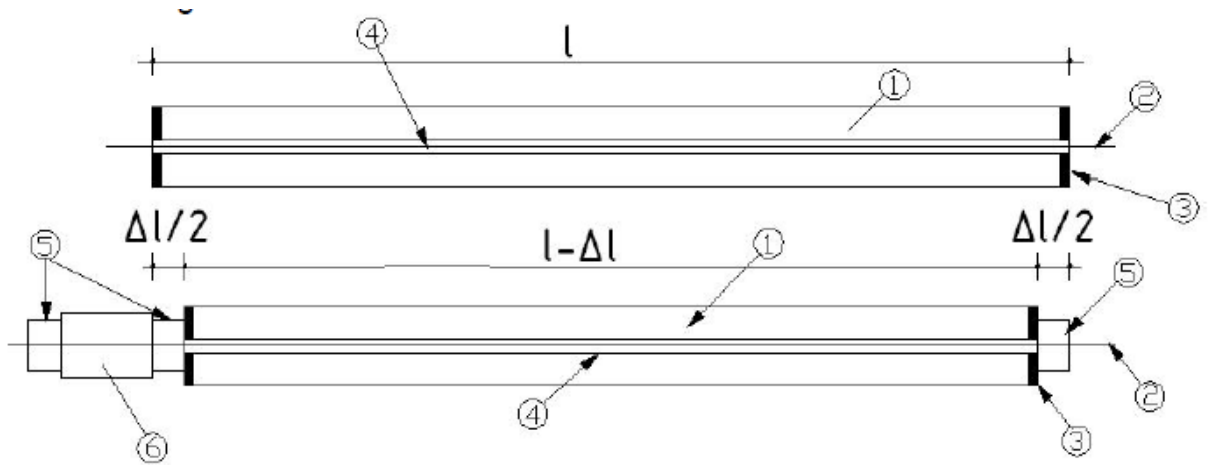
[5] Paranderja në beton 1- Elementi betonarme 2- Armaturë e tërhequr (paranderur) 3- Pllaka metalike 4- Kanali 5- Pajisjet kapëse (pyka) 6- Aparati tërheqës
